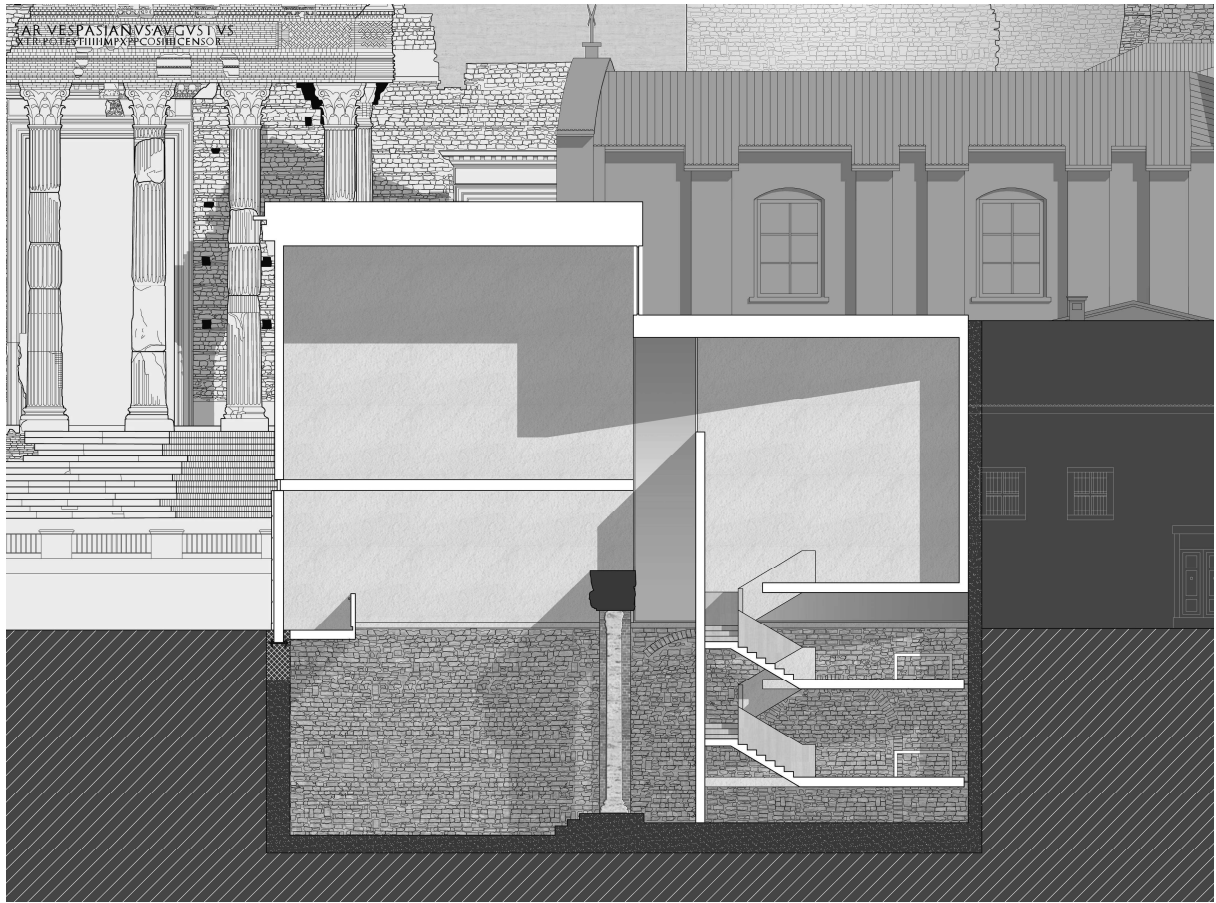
Sezione longitudinale verso il Capitolium dell'edificio di progetto in Piazza Foro
